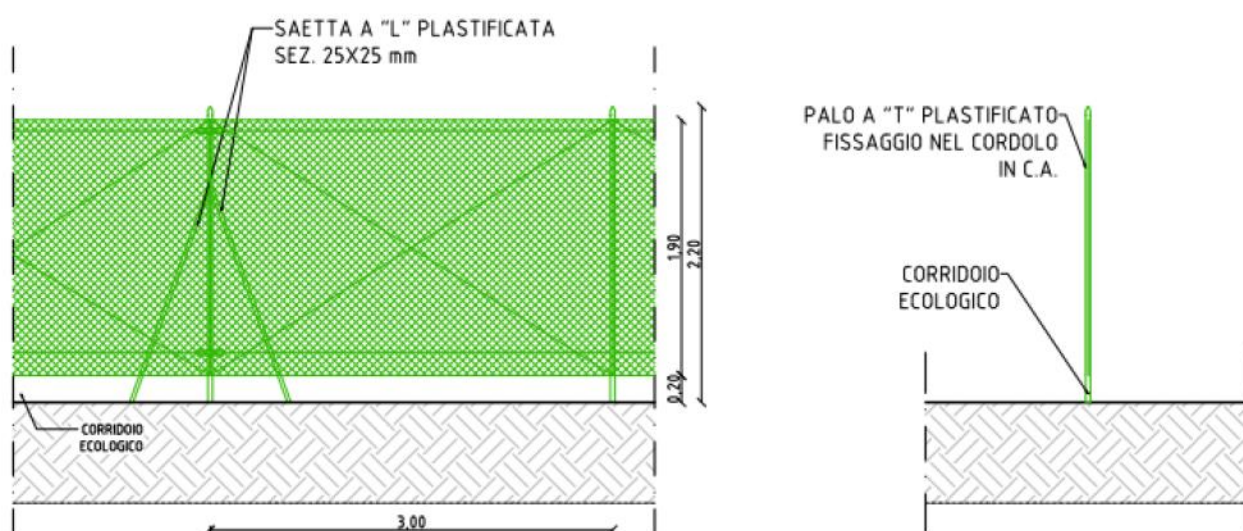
Dettaglio recinzione - Prospetto e sezione
